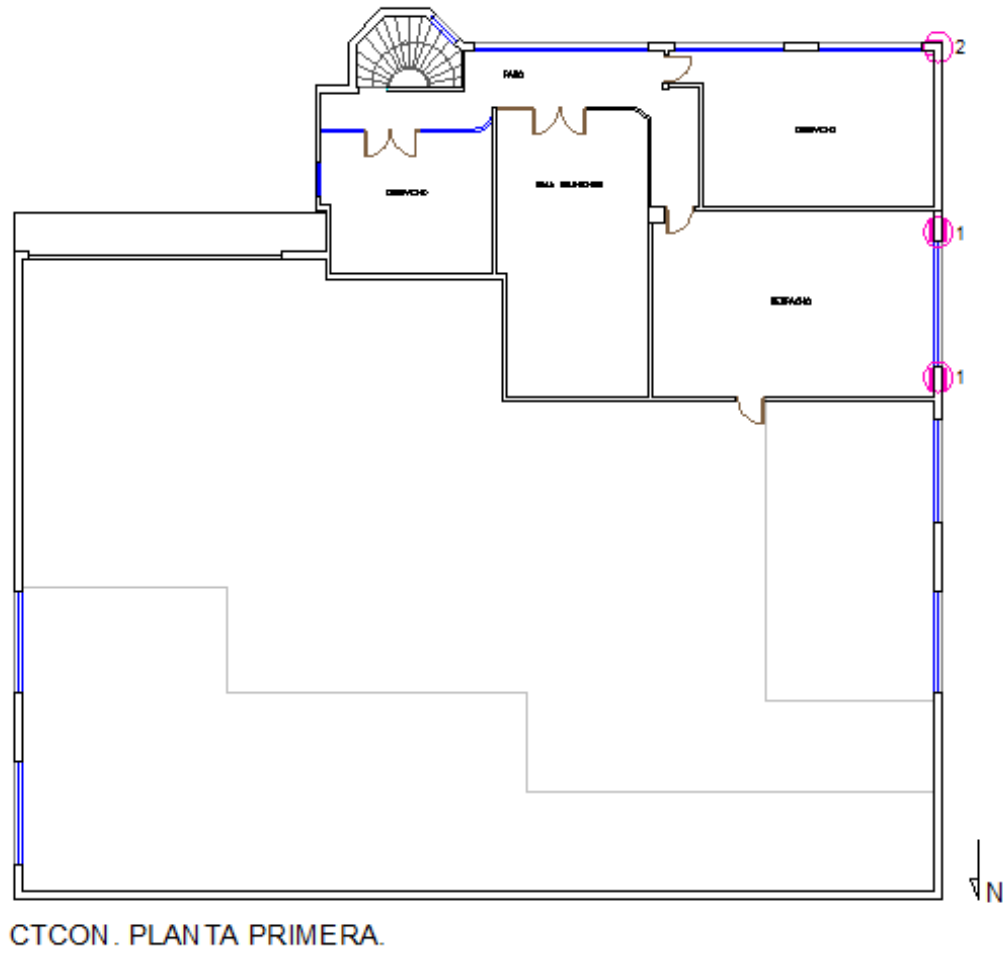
Puntos donde se ha realizado la prueba termoflujometrica. Planta primera del Centro Tecnológico de la Construcción. Murcia.
